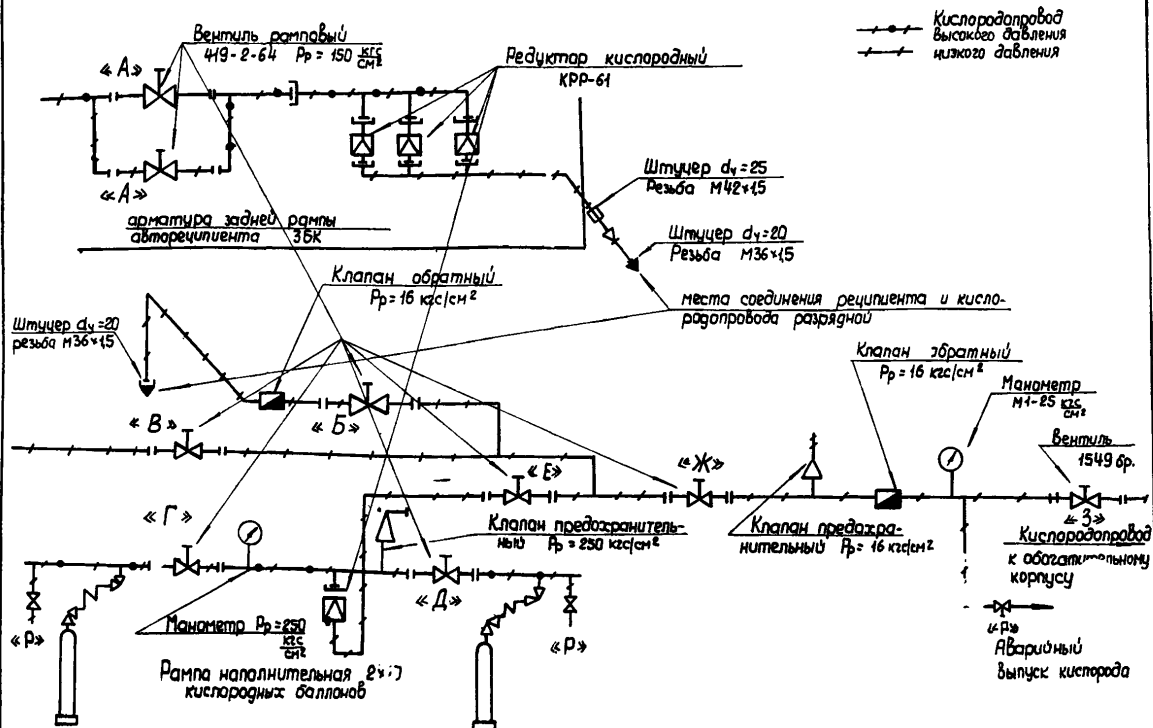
Схема монтажных соединений батареи 3БК с кислородопроводом разрядной.
